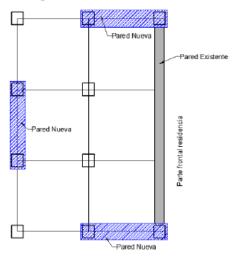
Vista en Planta de Casa en Zancos con Posible Localización de las Paredes Nuevas
